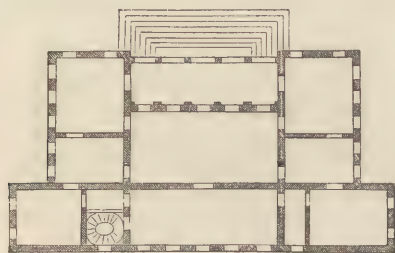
und 44. Villa Borghese zu Rom. Grundriss und Ansicht.
